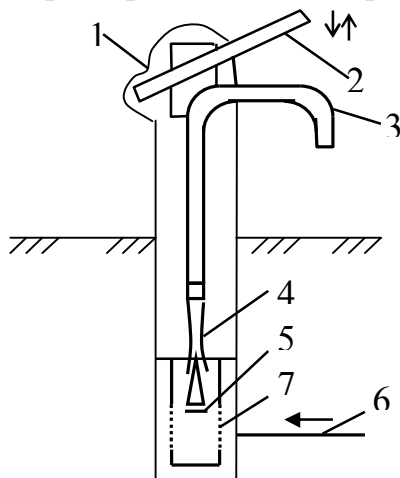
Схема конструкції водорозбірної колонки
